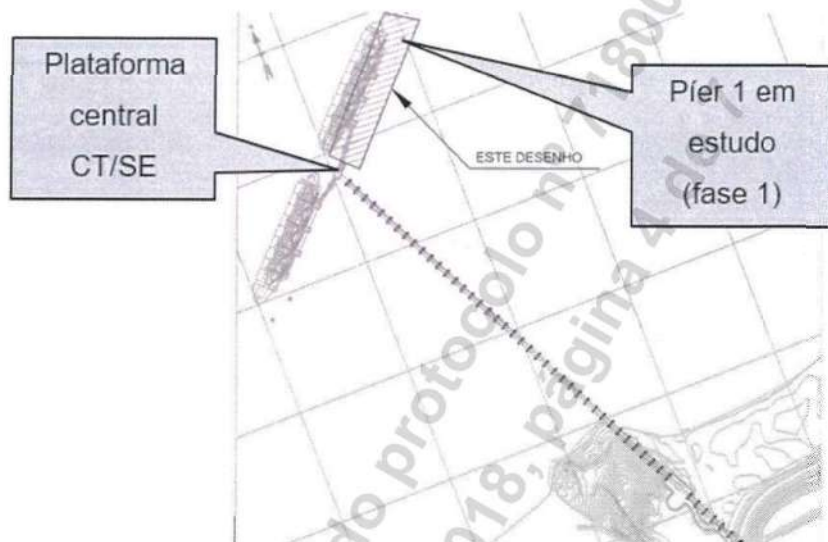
Arranjo Geral – Píer 1 – Fase 1
